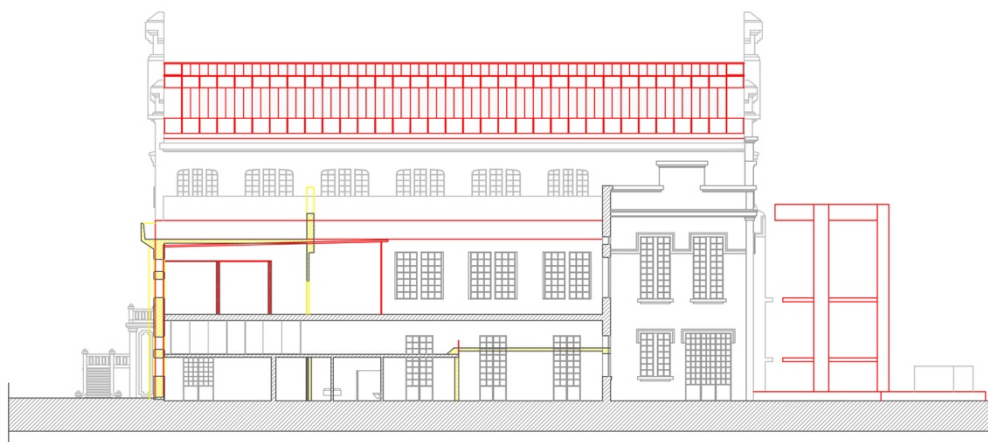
Sobreposição dos elementos a construir e a demolir, corte d;
